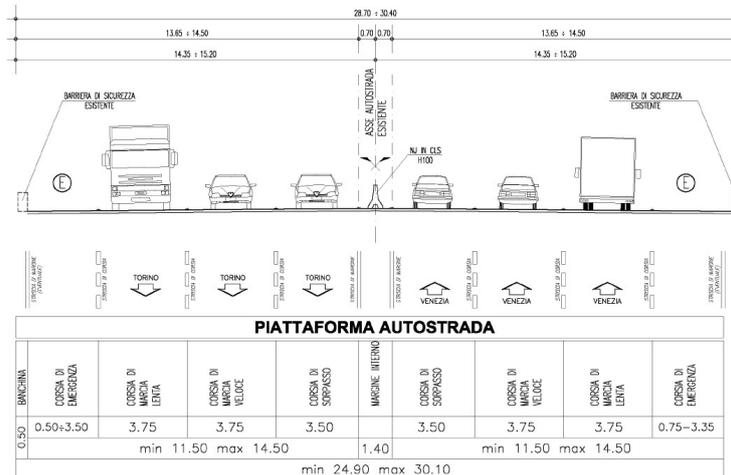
Sezione tipo del tratto di Autostrada A4 prima degli interventi in progetto
